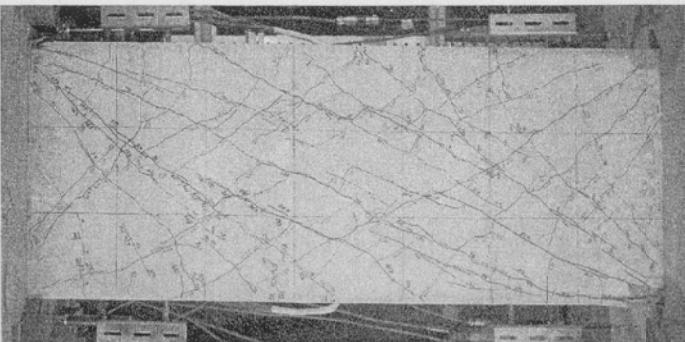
通常のコンクリート。数は少ないがひび割れの幅が大きい
